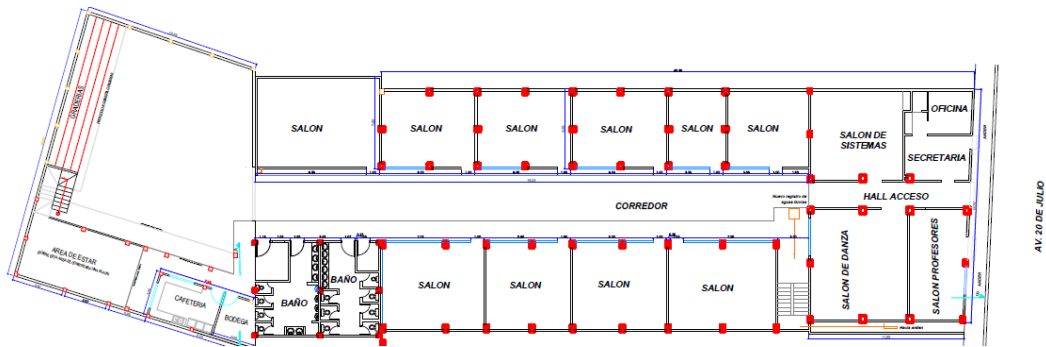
Planta 1er Piso Colegio. Nueva. CAJASAI.
